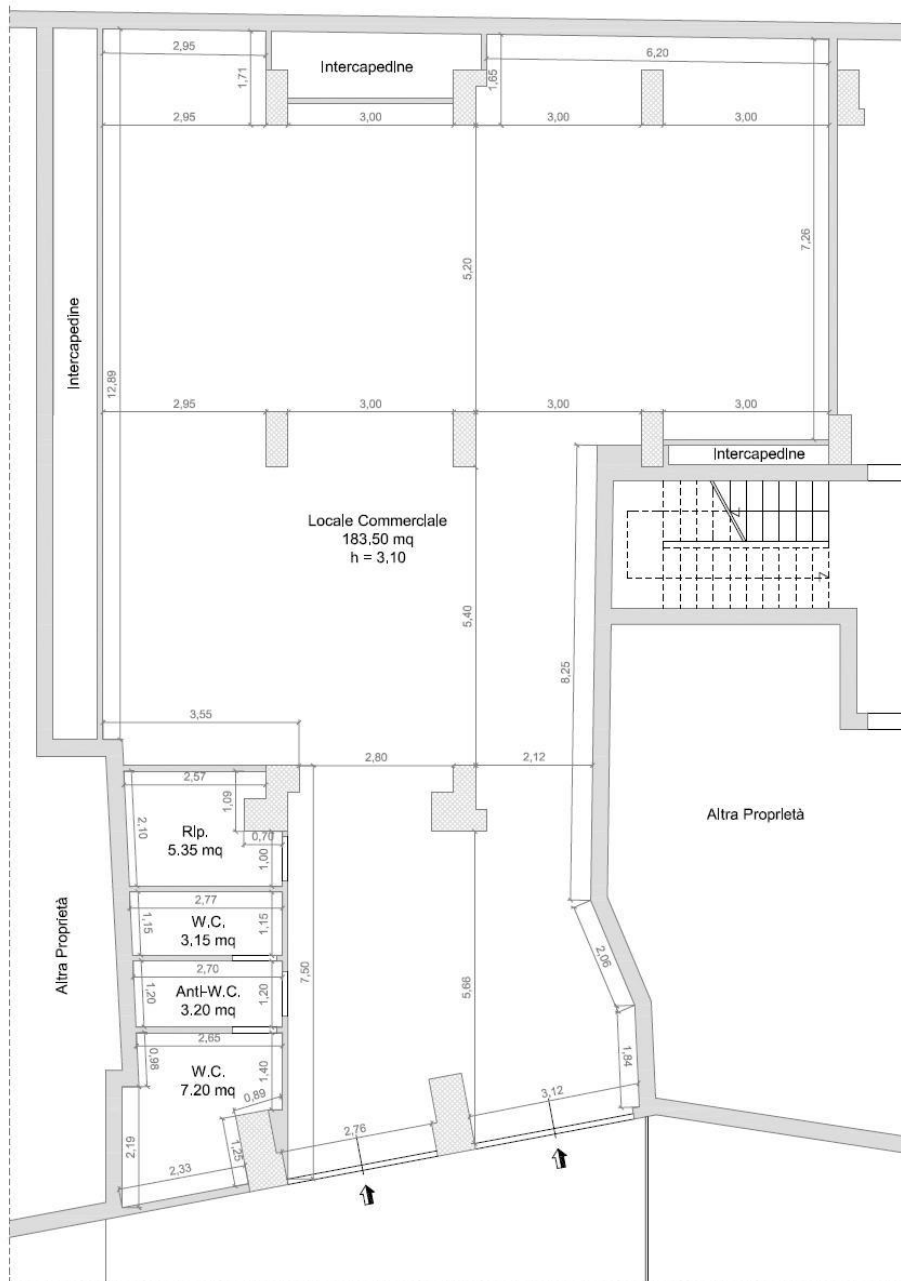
Planimetria Stato di fatto Foglio 105, p.lla 567, sub 75 (ex sub 48).
